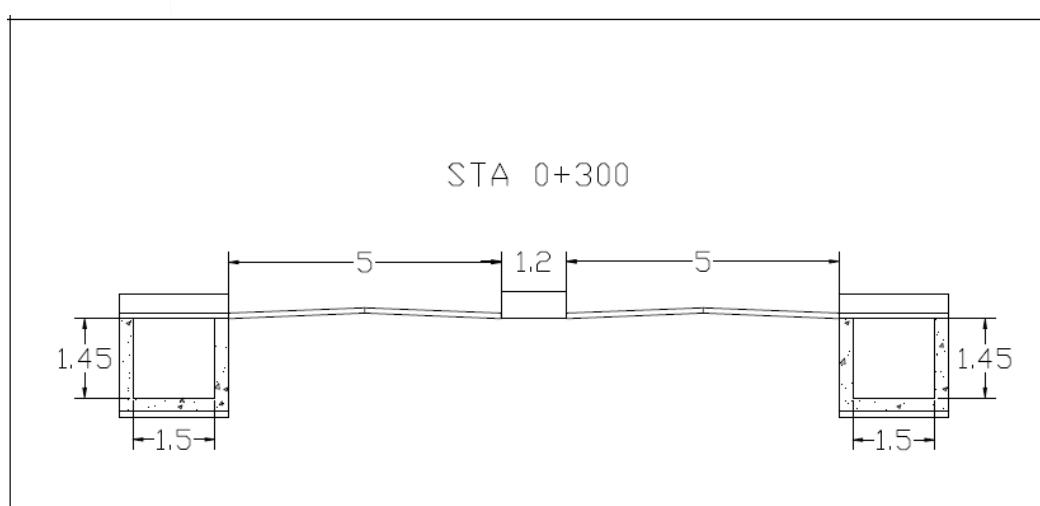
Long Section Jalan Jenderal Sudirman
